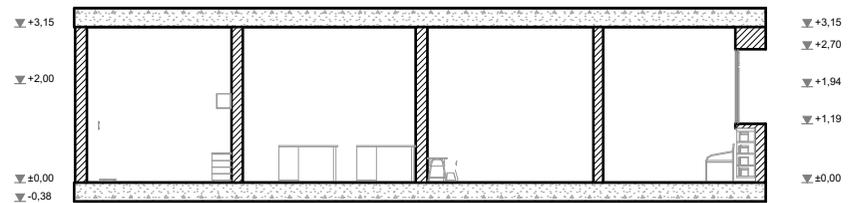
Planta de estado actual CEDIUC Fuente: Propia
